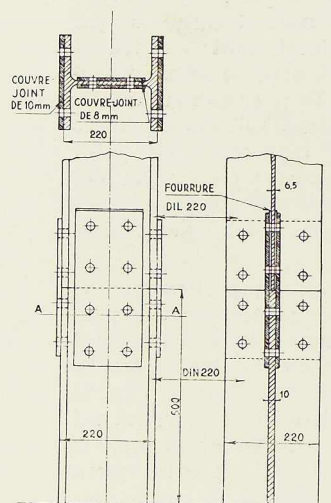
Assemblage type d'une poutrelle Grey D.I.N., avec une poutrelle D.I.L. de même hauteur.
